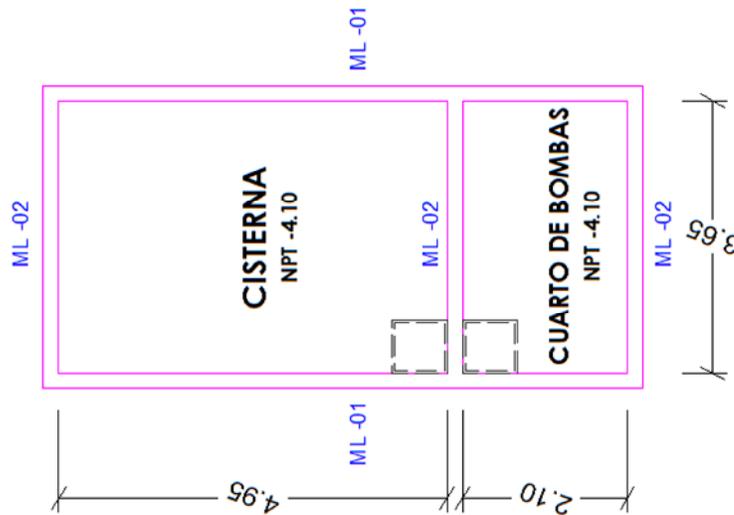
Vista en Planta de la Cisterna a Diseñar.
